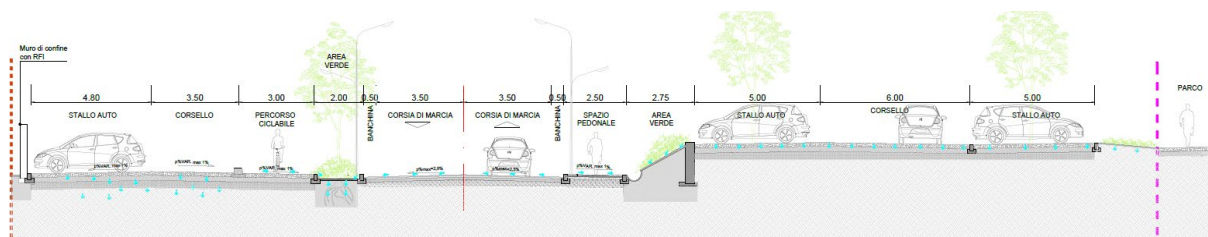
Sezione nuova strada e nuovo parcheggio cimitero
